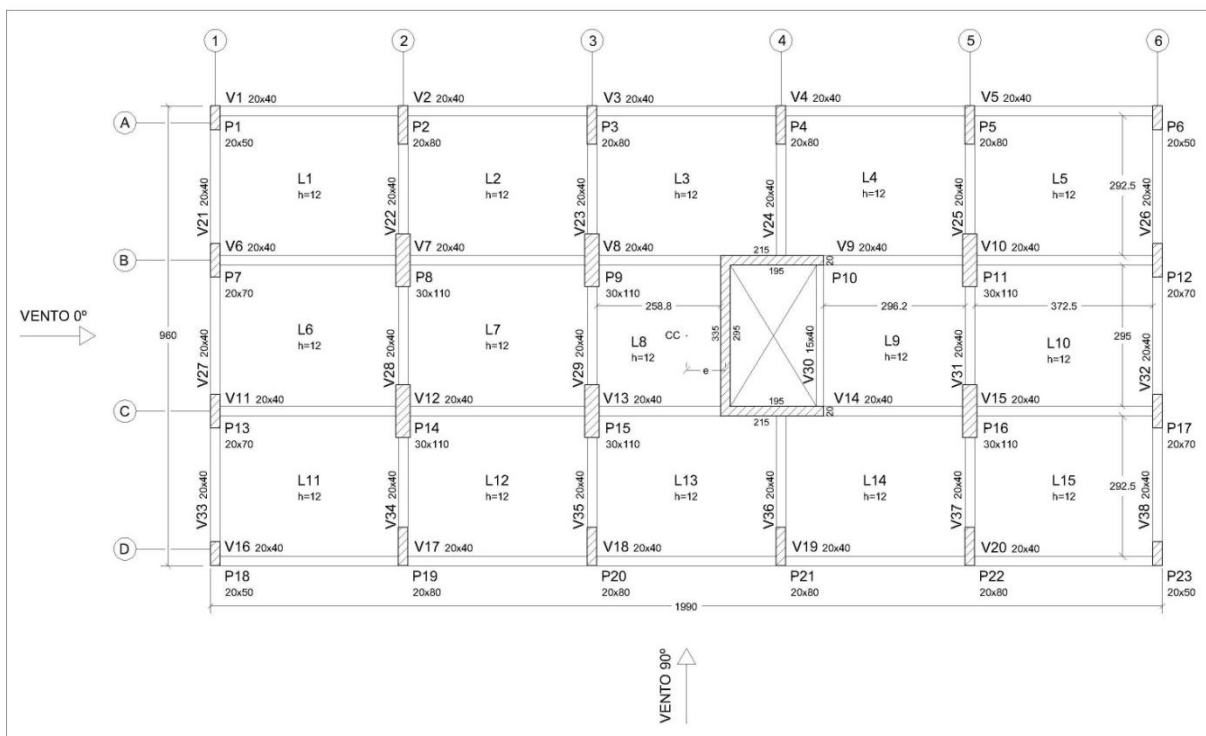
Planta de formas do exemplo numérico 1 – 15 pavimentos – pilares redimensionados
